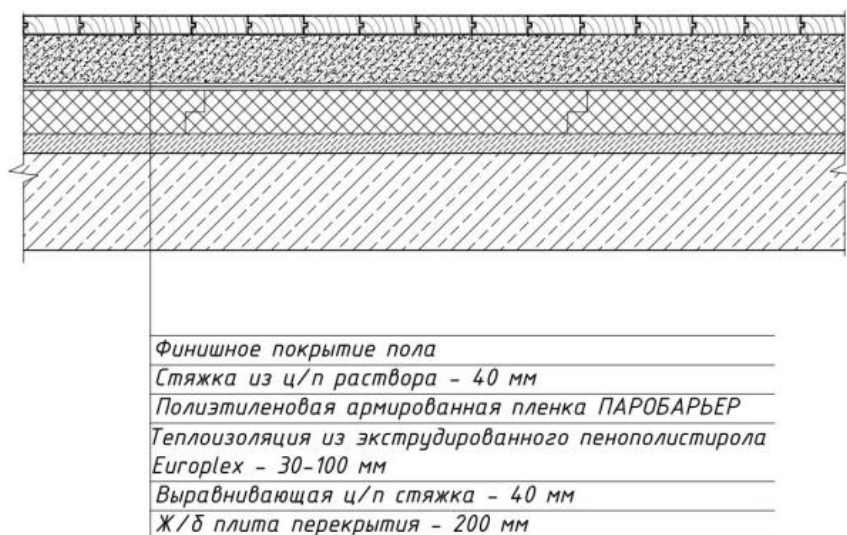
Узел 2. Перекрытие с детализацией конструкций
